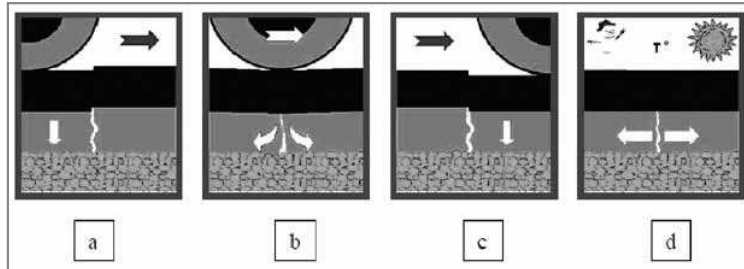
Sollicitaciones de las fisuras de un pavimento.
